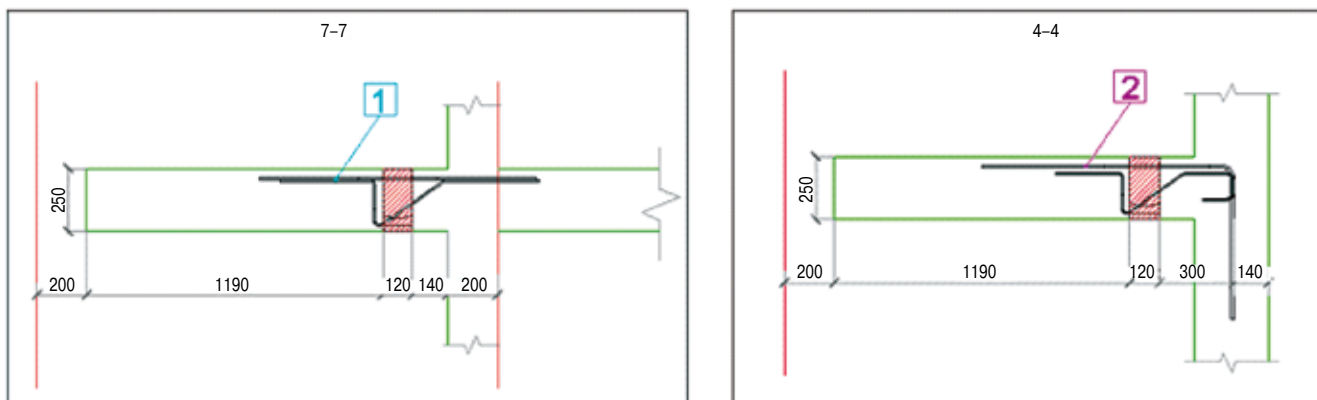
Варианты Schöck Isokorb, служащие для крепления балконных плит к различным конструктивным частям зданий: 1 – крепление к ж/б перегородию; 2 – крепление к несущей ж/б стене в зоне второго света
